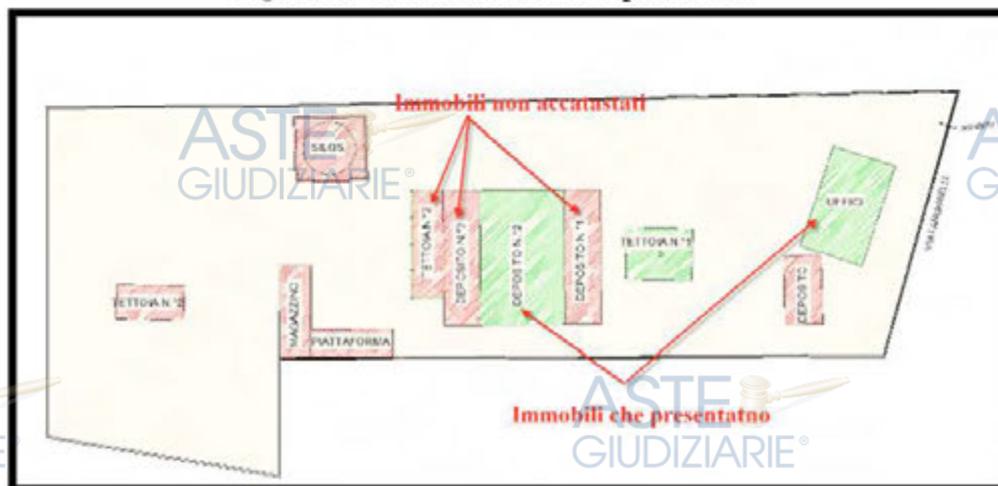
Planimetria generale - Individuazione immobili non accatastati
